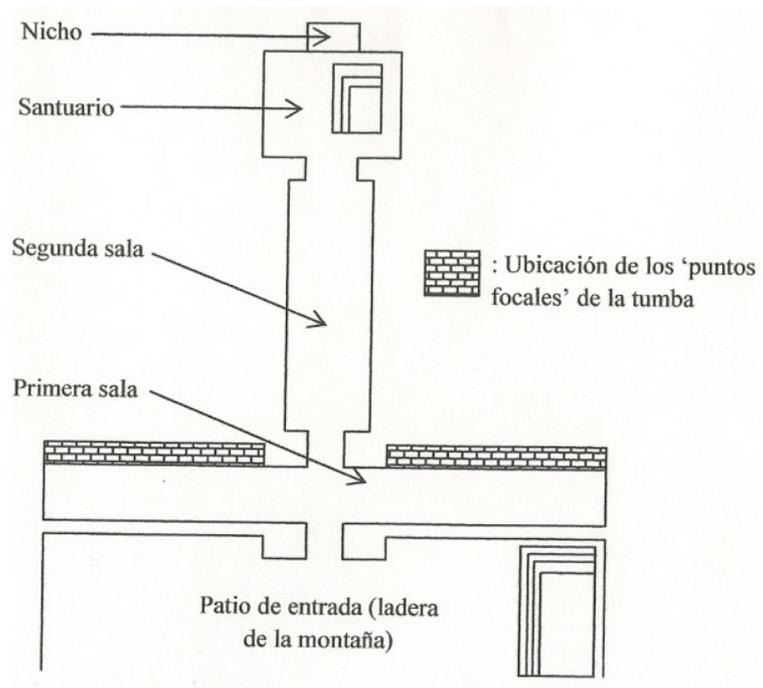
Planta general de una tumba rupestre (Adaptado de Kanawati, 1987: 83)
